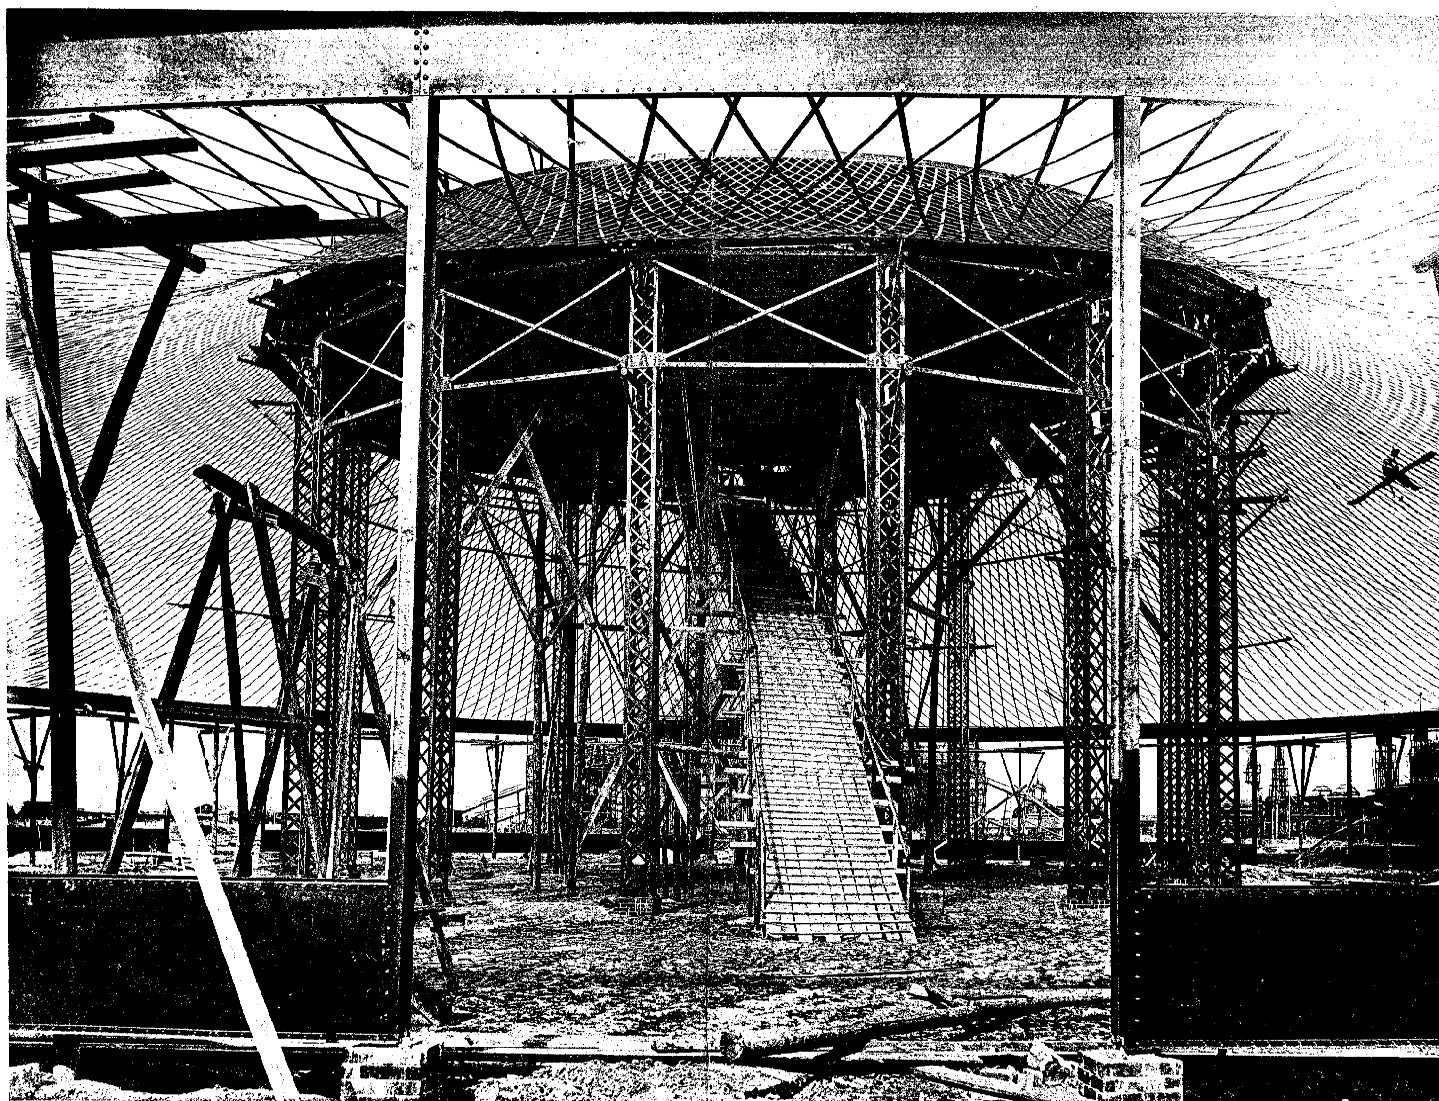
Сетчатое покрытие системы инженера В.Г. Шухова: - павильон круглого плана в период строительства, вид снаружи на наружное и внутреннее опорные кольца и висящую сетку из стальных пересекающихся полос. Фото А.О. Карелина от 21.06.1895 г.
